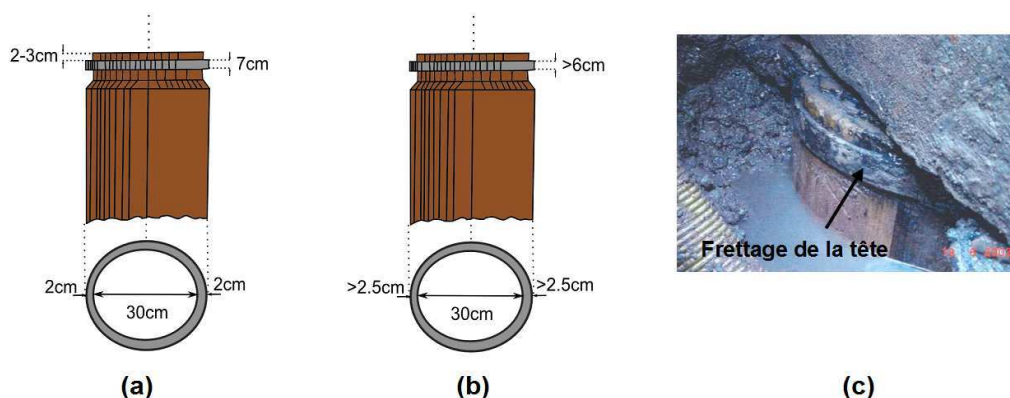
Frettage des pieux en bois (a) et (b) – frettage de pieux de fondation employé aux Pays-Bas (c)
